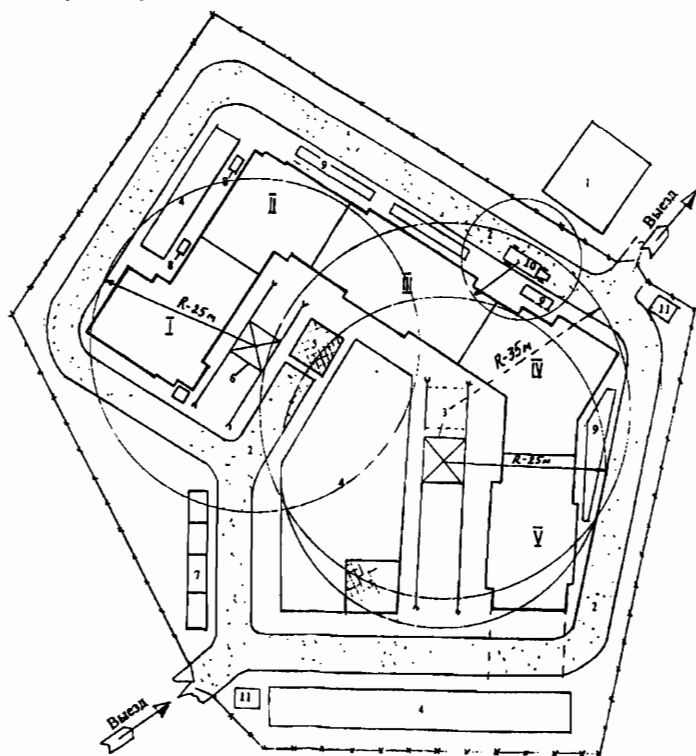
План строительной площадки пятисекционного жилого дома: I – секция 10 этажей; II – секция 12 этажей; III – секция 14 этажей; IV – секция 16 этажей; V – секция 14 этажей. 1 – существующее здание, используемое для нужд строителей; 2 – автомобильная дорога; 3 – башенный кран КБ-674; 4 – зона складирования конструкций и материалов; 5 – место приема бетона и раствора; 6 – башенный кран КБ-408; 7 – бытовые помещения; 8 – грузовые лифты; 9 – склад стеновых материалов; 10 – автокран; 11 – проходная
